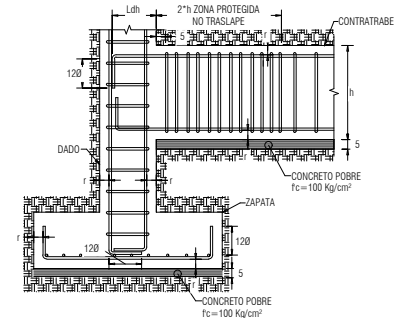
DETALLAMIENTO DE ESTRIBOS Y GANCHOS
